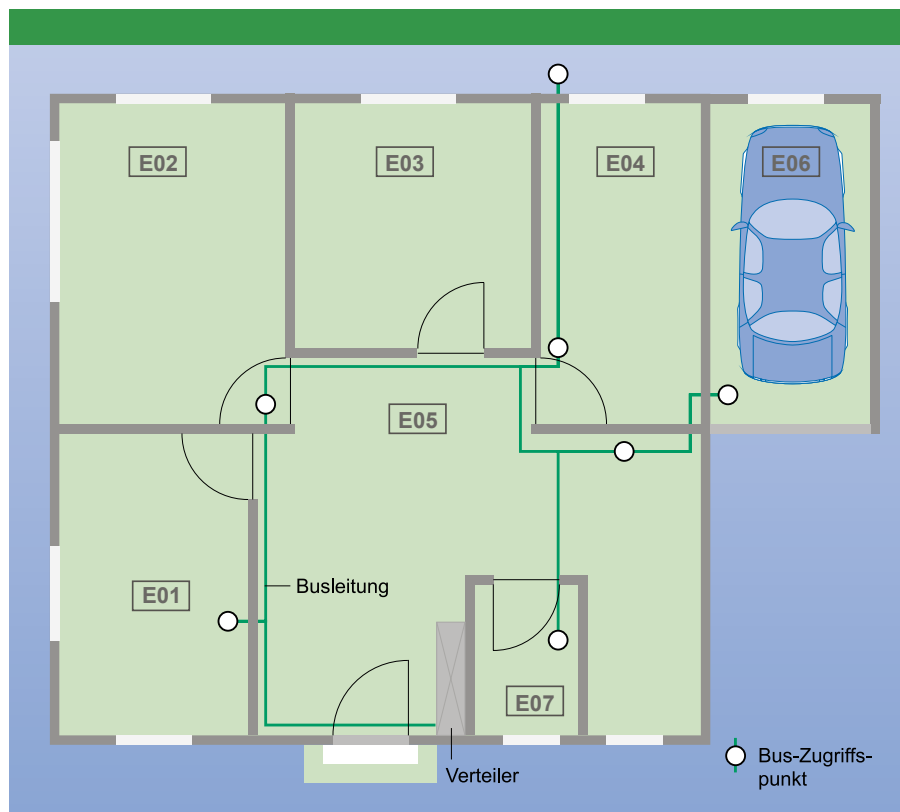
Grundriss mit Raumnummern (Quelle: KNX Swiss)
